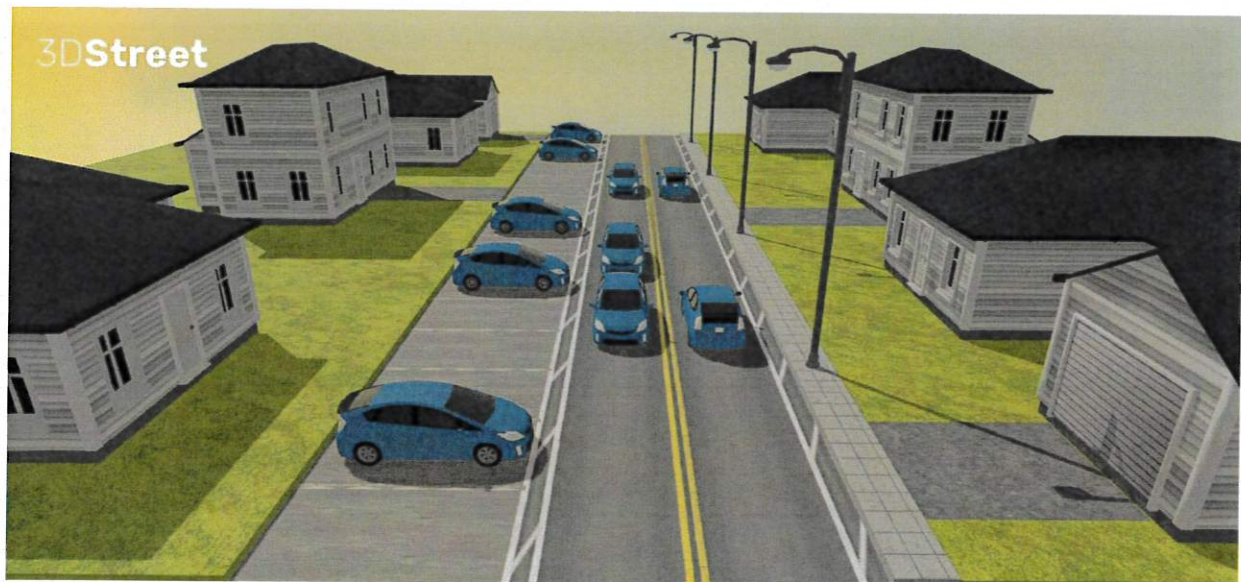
Vedere 3D profil transversal str. Andrei Mureșanu - situația existentă
